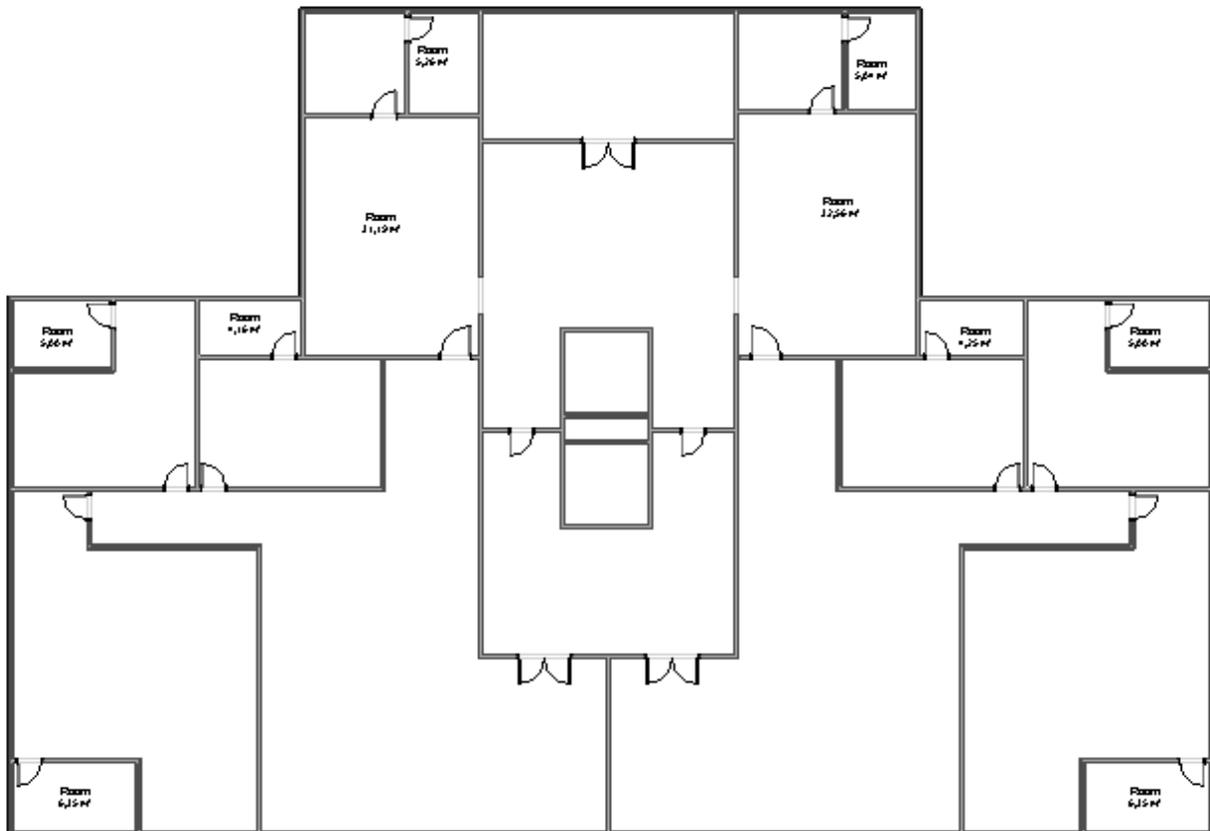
Planta Tipo 2 em Autodesk Revit 2017.
